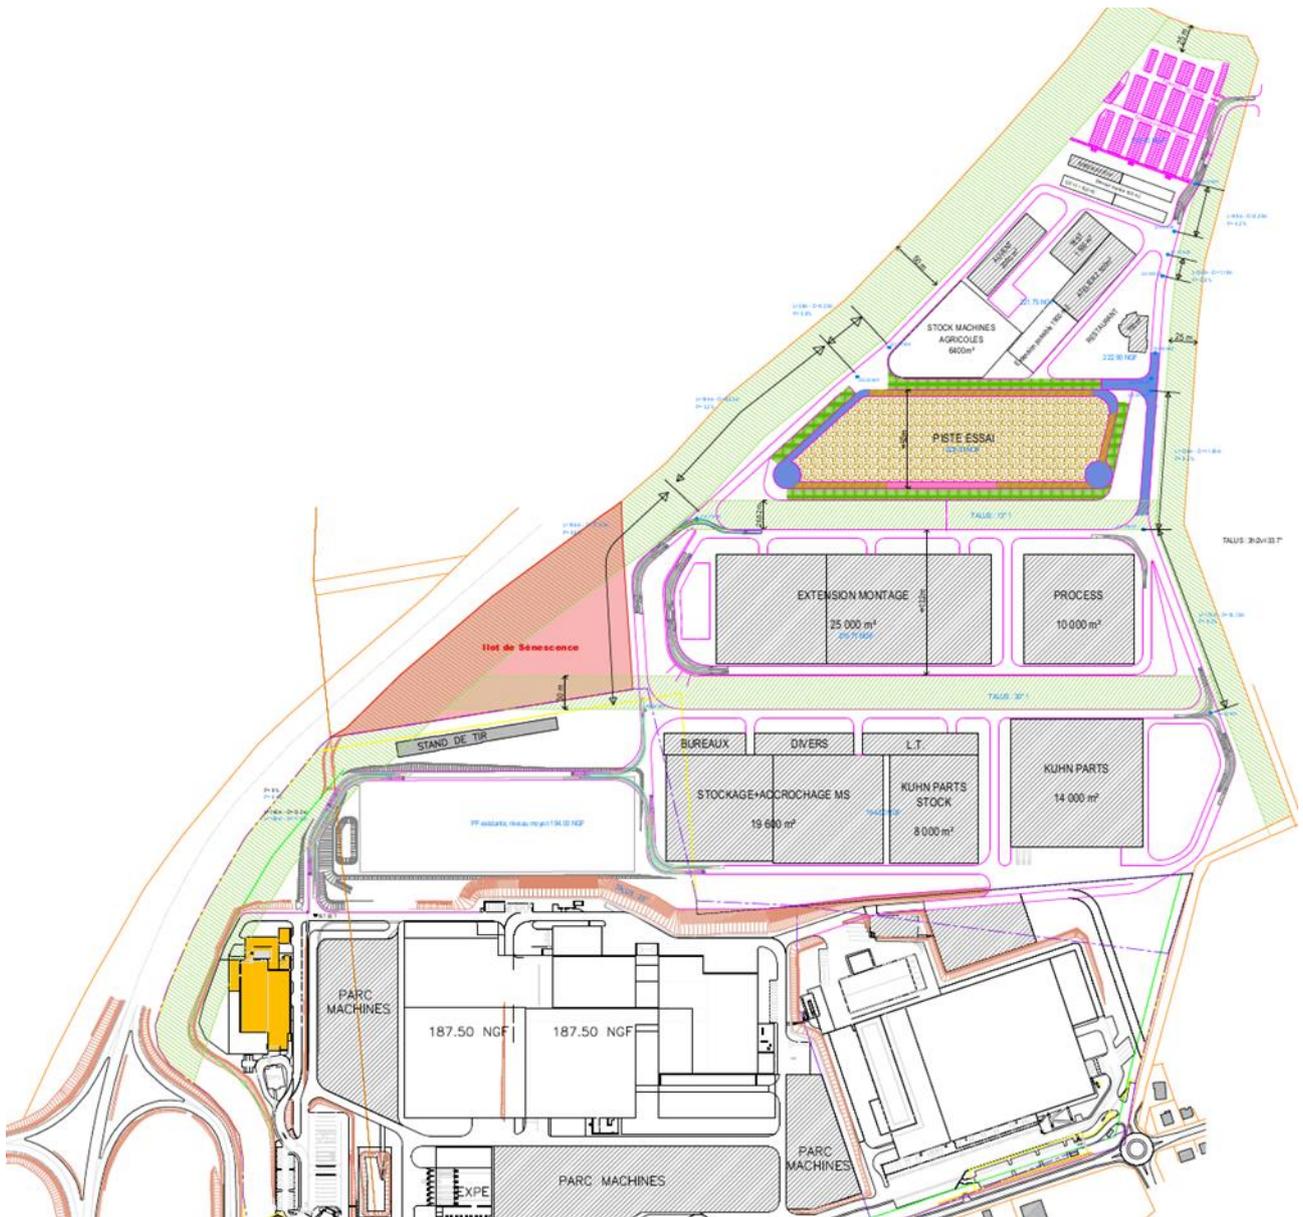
PLAN DU PROJET D'AGRANDISSEMENT DU SITE DE KUHN VARIANTE 2 (PLAN MASSE SEPTEMBRE 2020)
